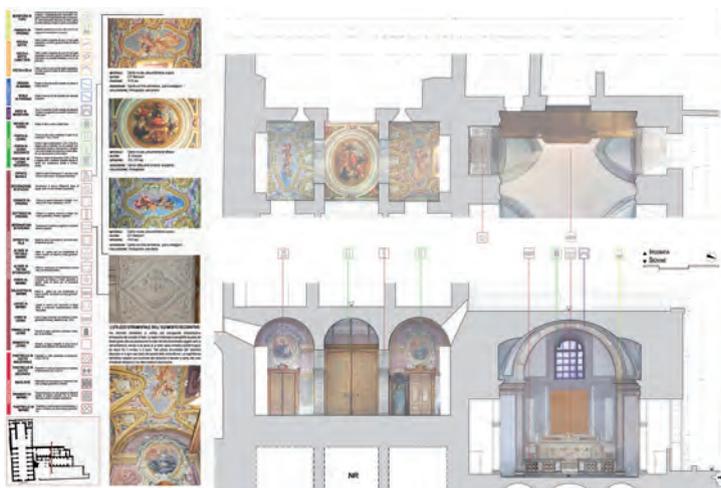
Mappa dei materiali: pianta di dettaglio e sezione longitudinale
